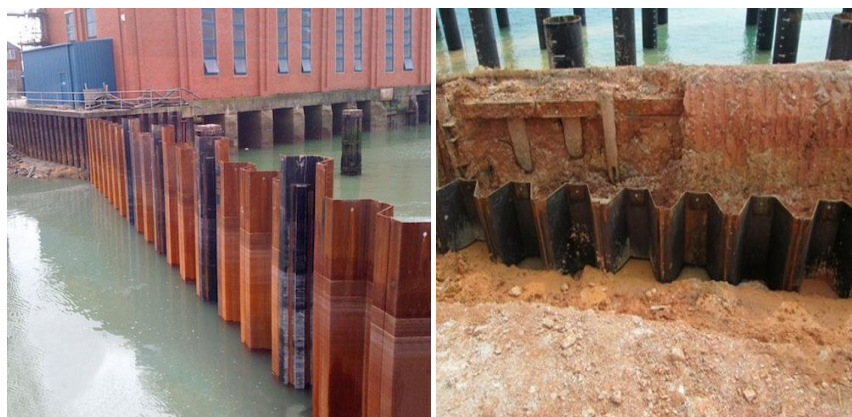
Exemples de l'utilisation de palplanches en acier
